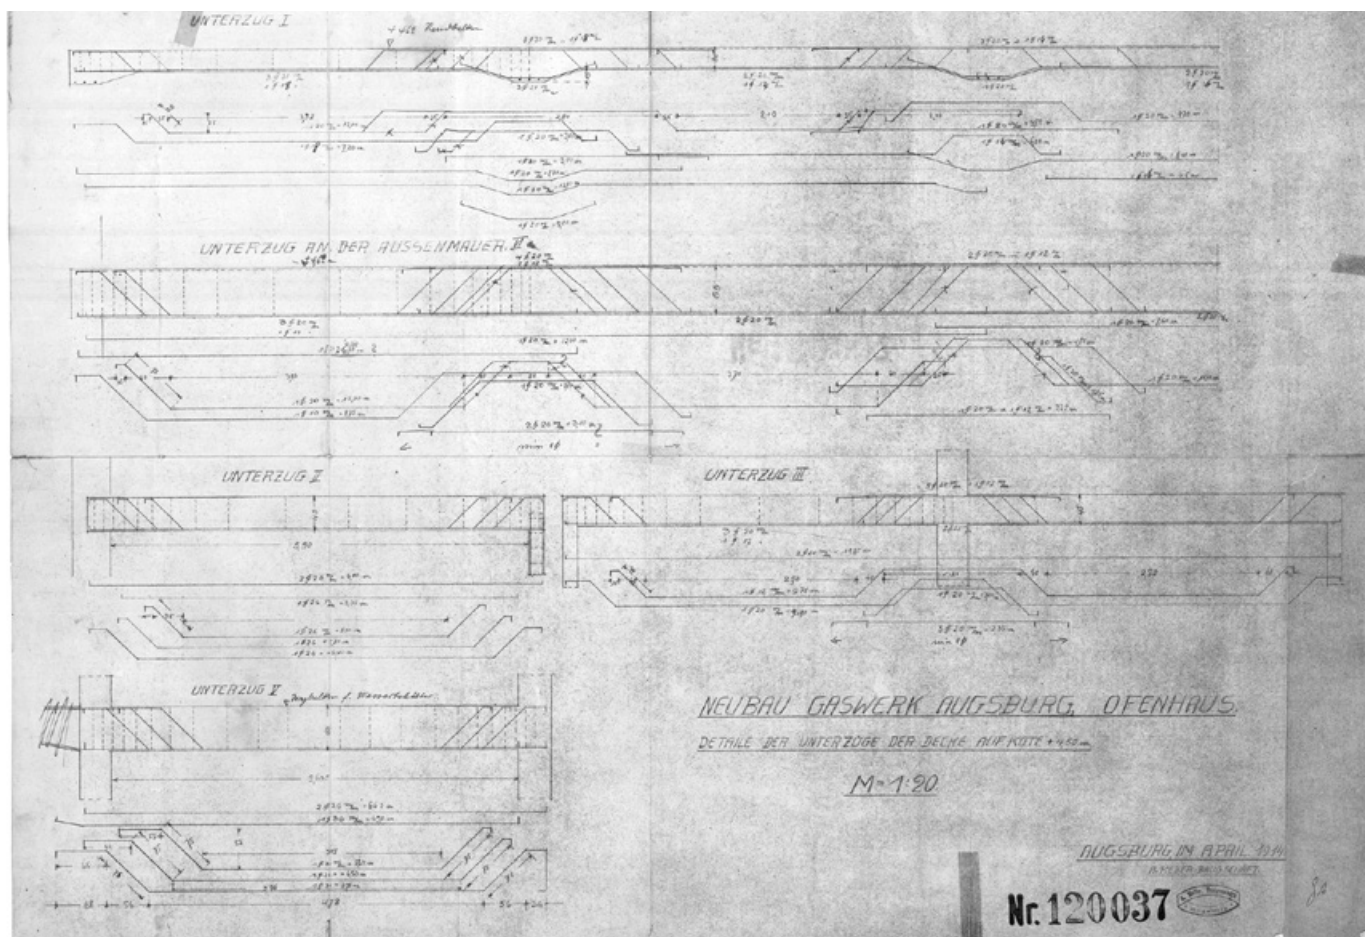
Bewehrungsplan der Deckenunterzüge (StadtAA, KPS 6811).
